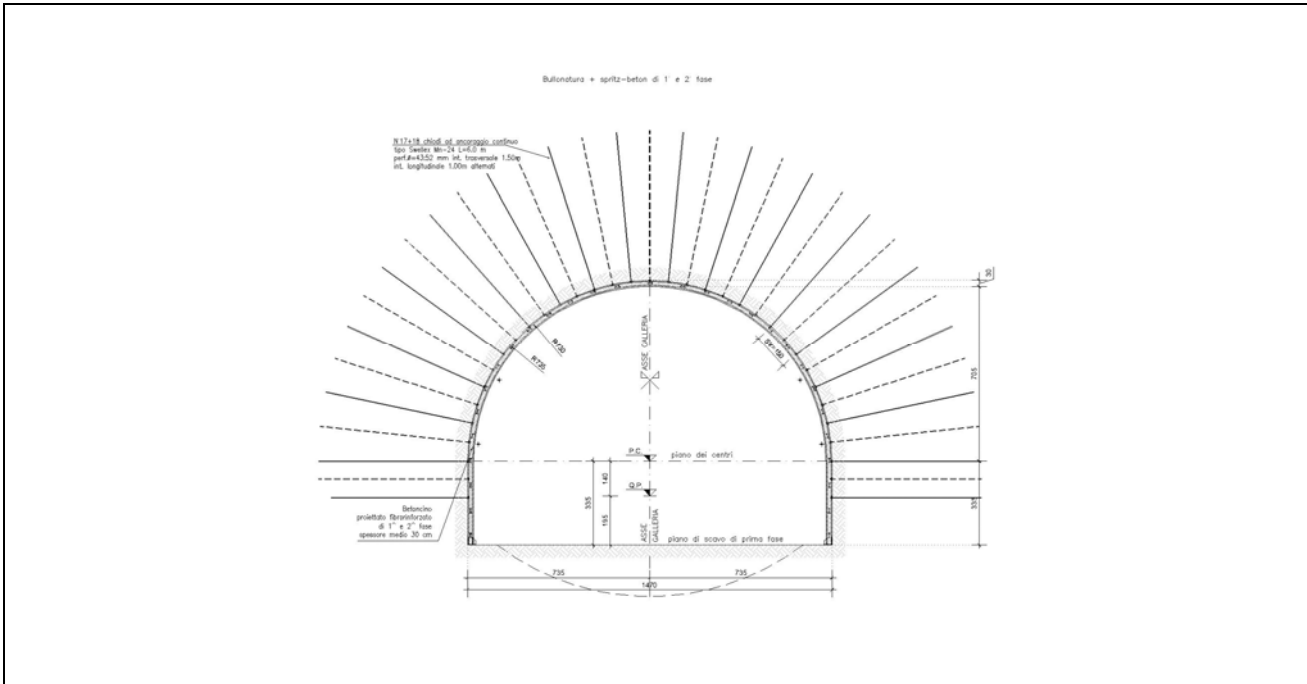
Sezione di scavo tipo GD-A2 - Sezione trasversale
